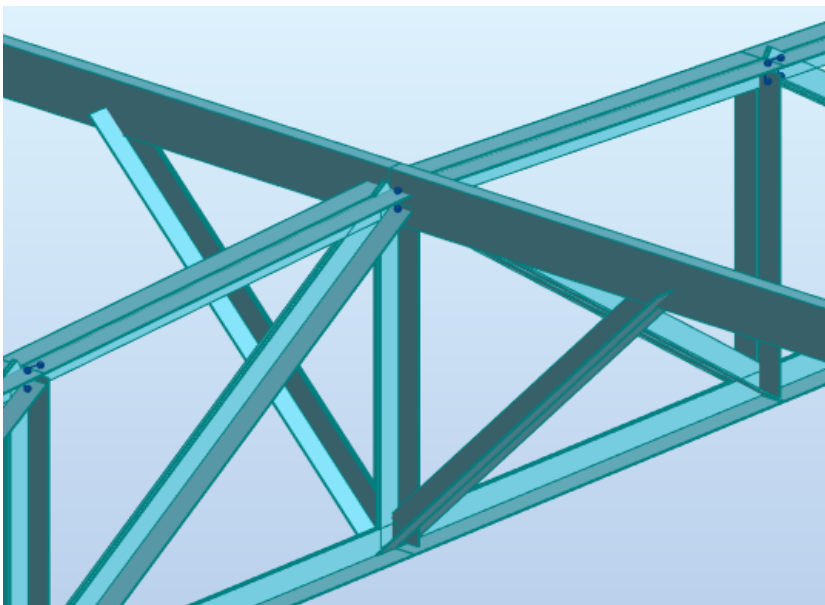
Perfis dos Elementos Estruturais da Treliça metálica
